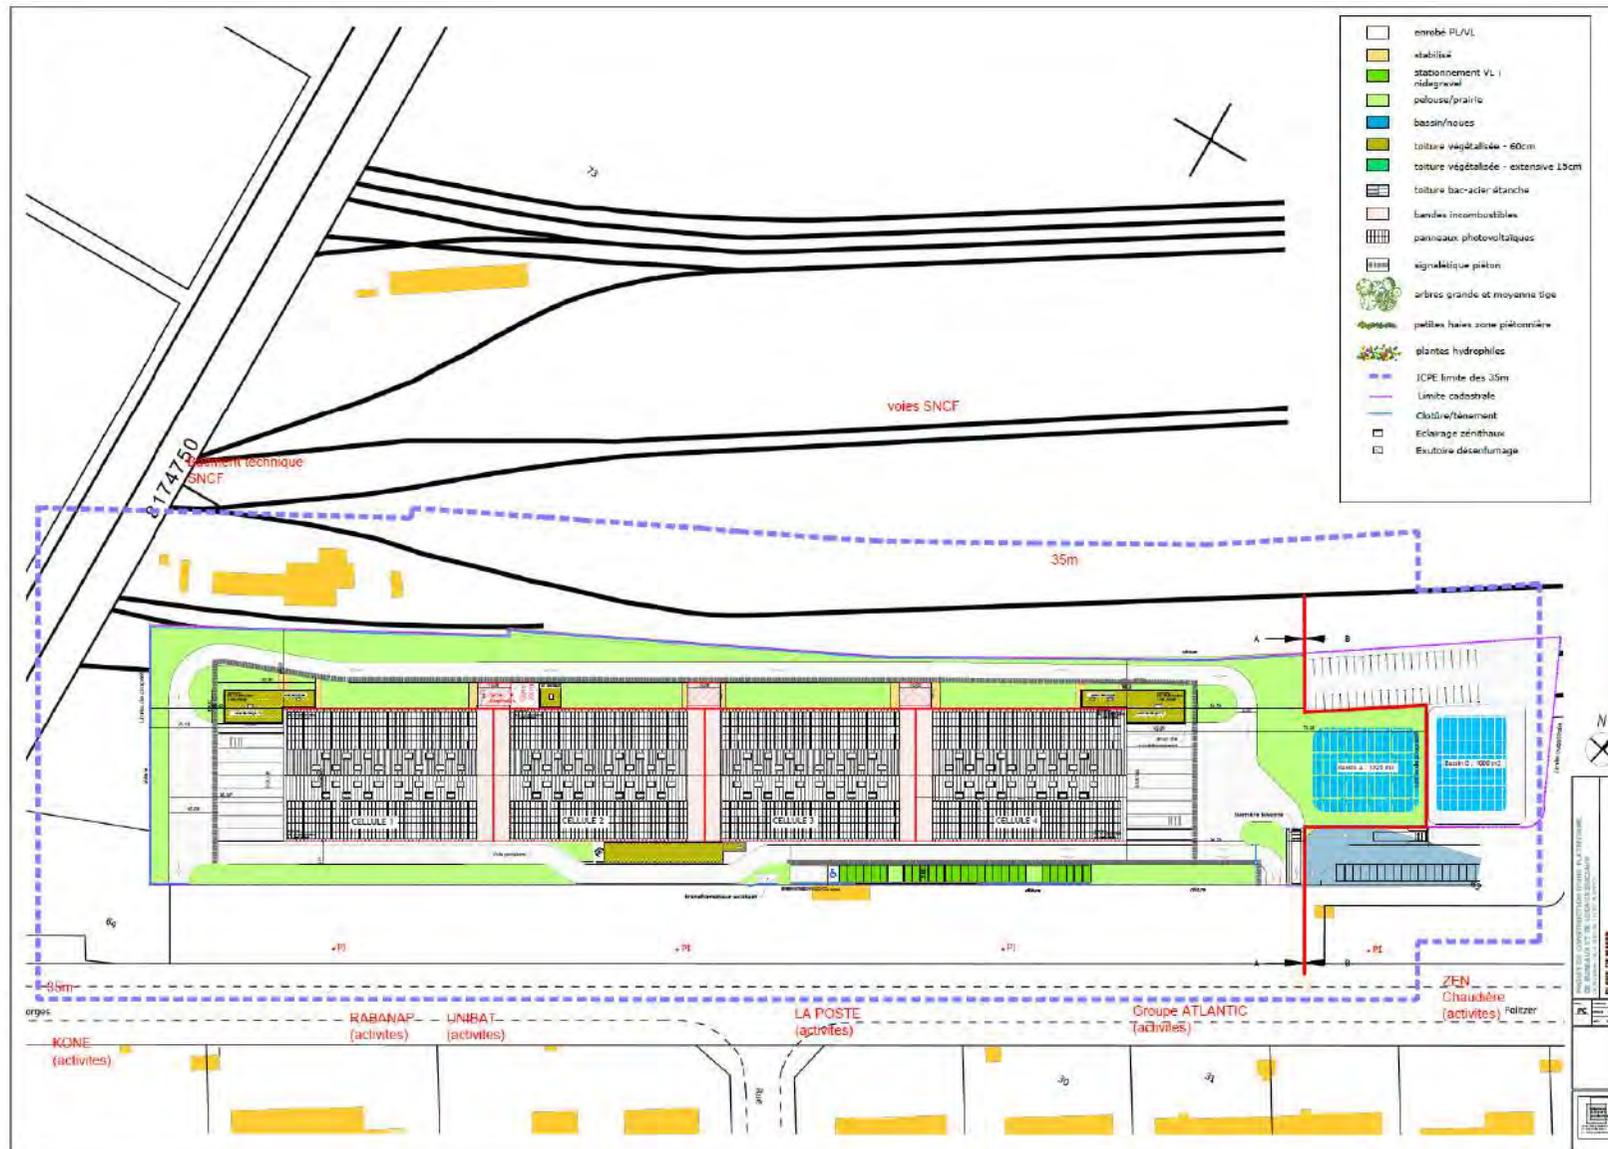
Plan de masse du projet (source : Architecte AUBEY Stéphane)
